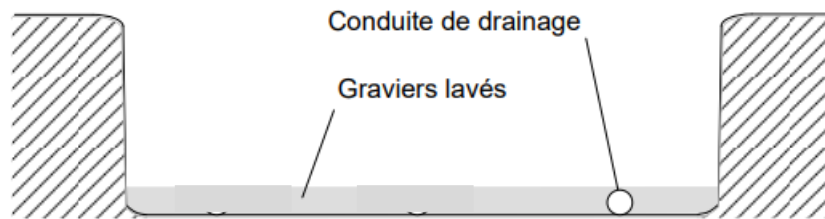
Vue en coupe de l'excavation avec la couche de gravier lavé 10/40 mm
